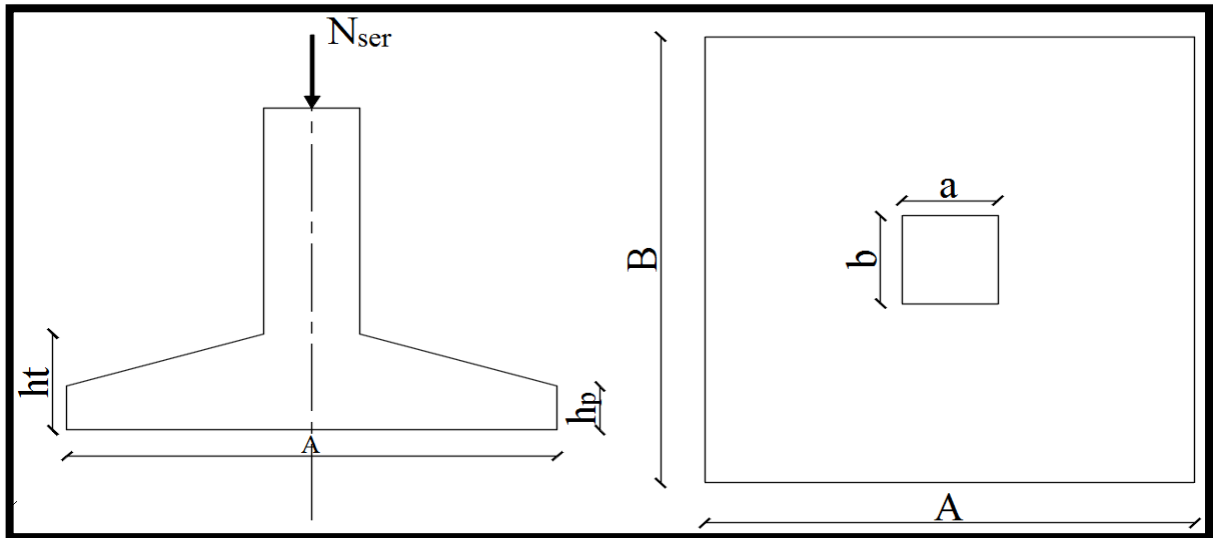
Schématization (2D) des semelles isolées sous poteaux.
